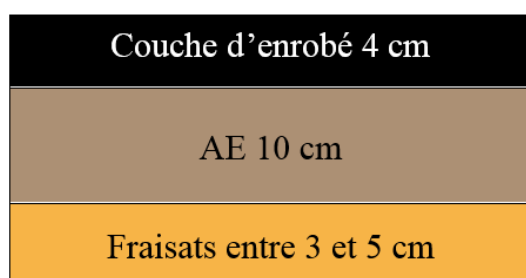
Structure de chaussée de la planche expérimentale suisse
